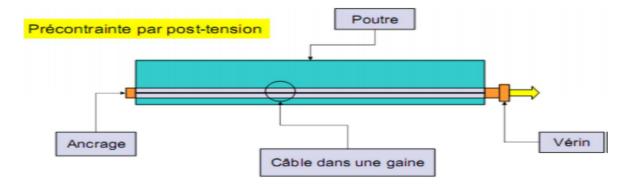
Coupe longitudinal d'une poutre en béton précontraint par post-tension
